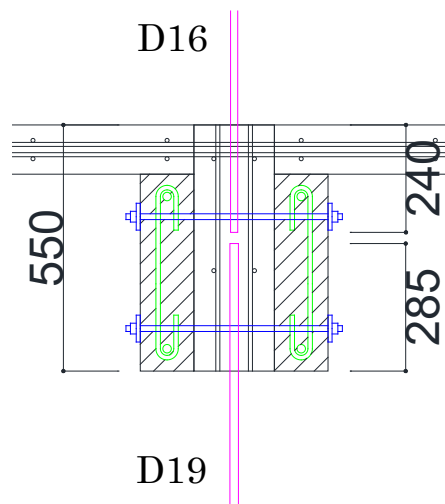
2F 壁梁に施工するあと施工アンカー
